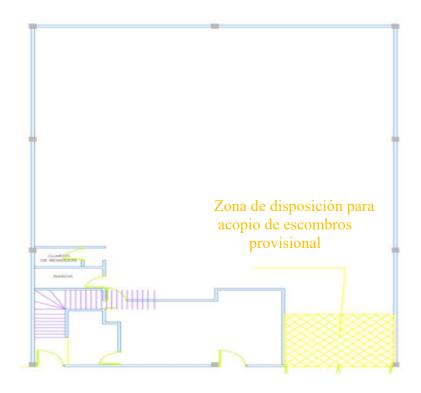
Levantamiento de la primera planta para determinar zona de acopio
